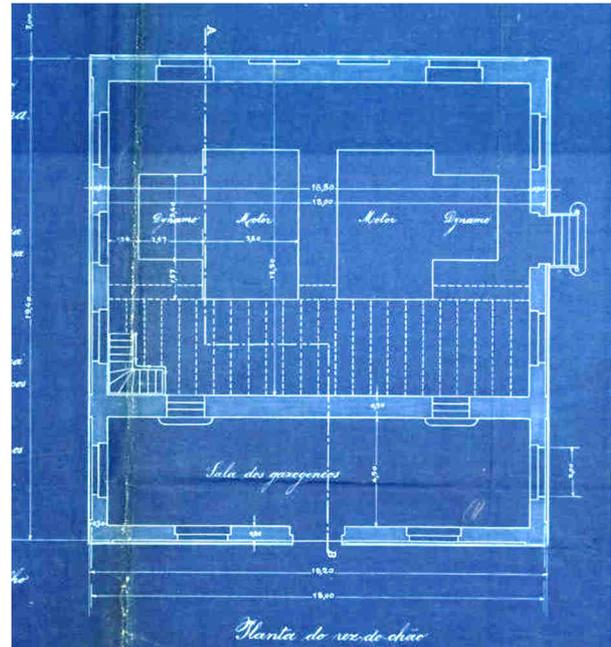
Casa das Máquinas, planta do rés-do-chão, (AML, Obra 24497, Nº 4691/1908, fl. 6).
